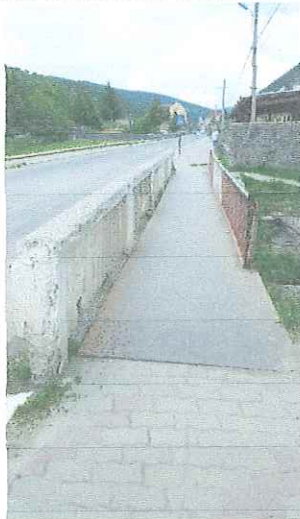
Detaliiu consola trotuar cu podina din tabla striata. Parapetul existent este degradat, cu beton exfoliat, si armatura la vedere.
